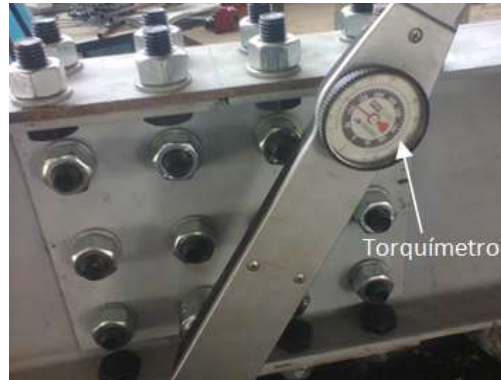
Uso do torquímetro para fixar os parafusos
